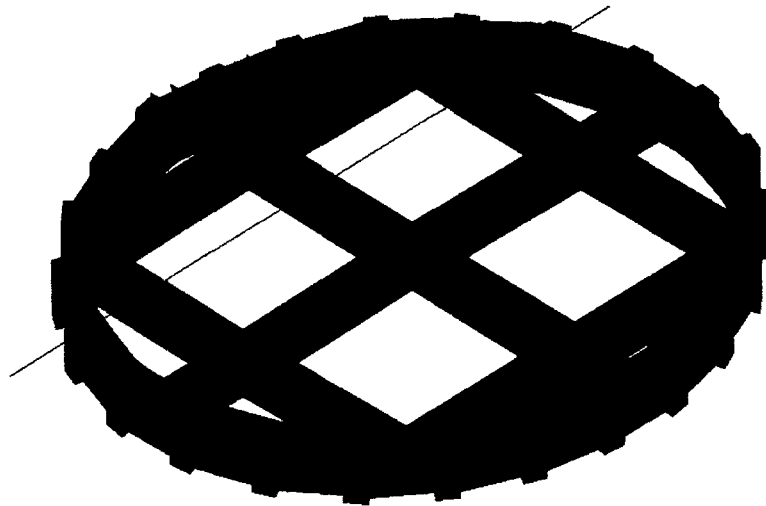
Viga tubular rectangular del anillo central de planchas de acero A-36.
